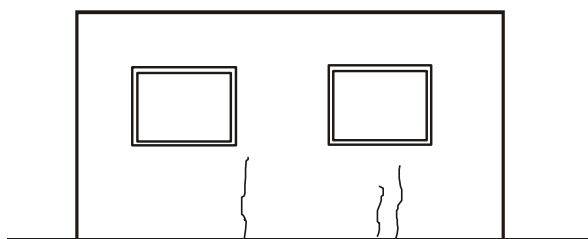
fissuras verticais junto ao solo por ruptura das fundações (DUARTE, 1998)
